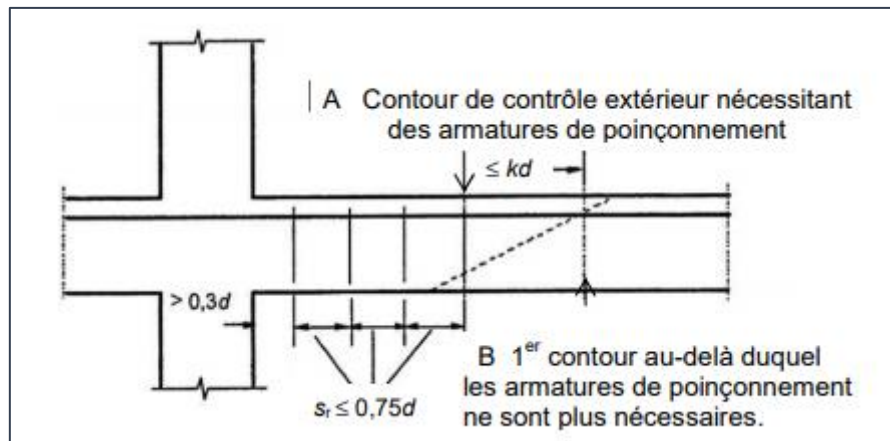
Armatures de poinçonnement, espacements des armatures, (EC 2-1-1, Fig. 9.10a)
